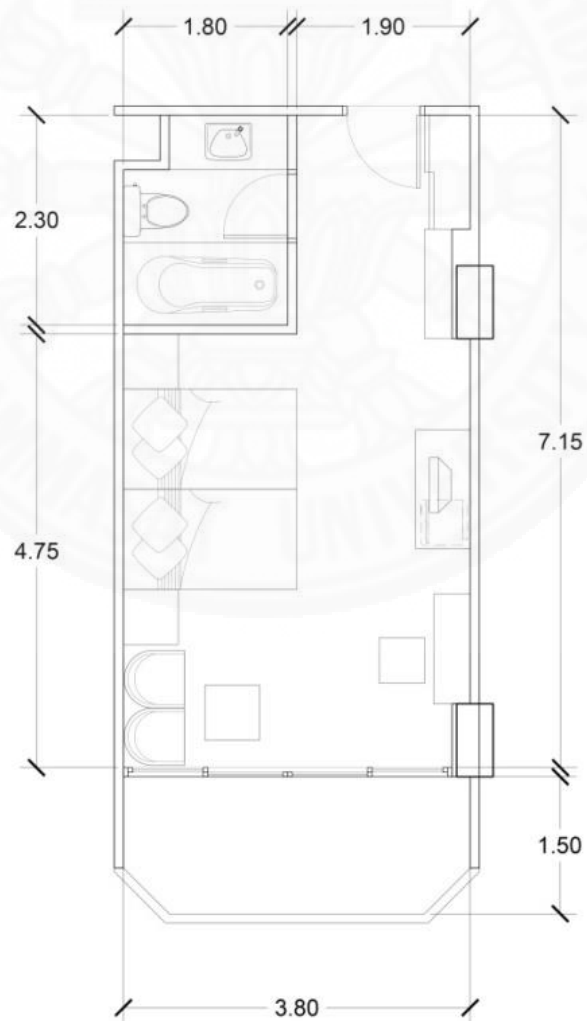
แสดงผังชั้นที่ 2 โครงการ B
